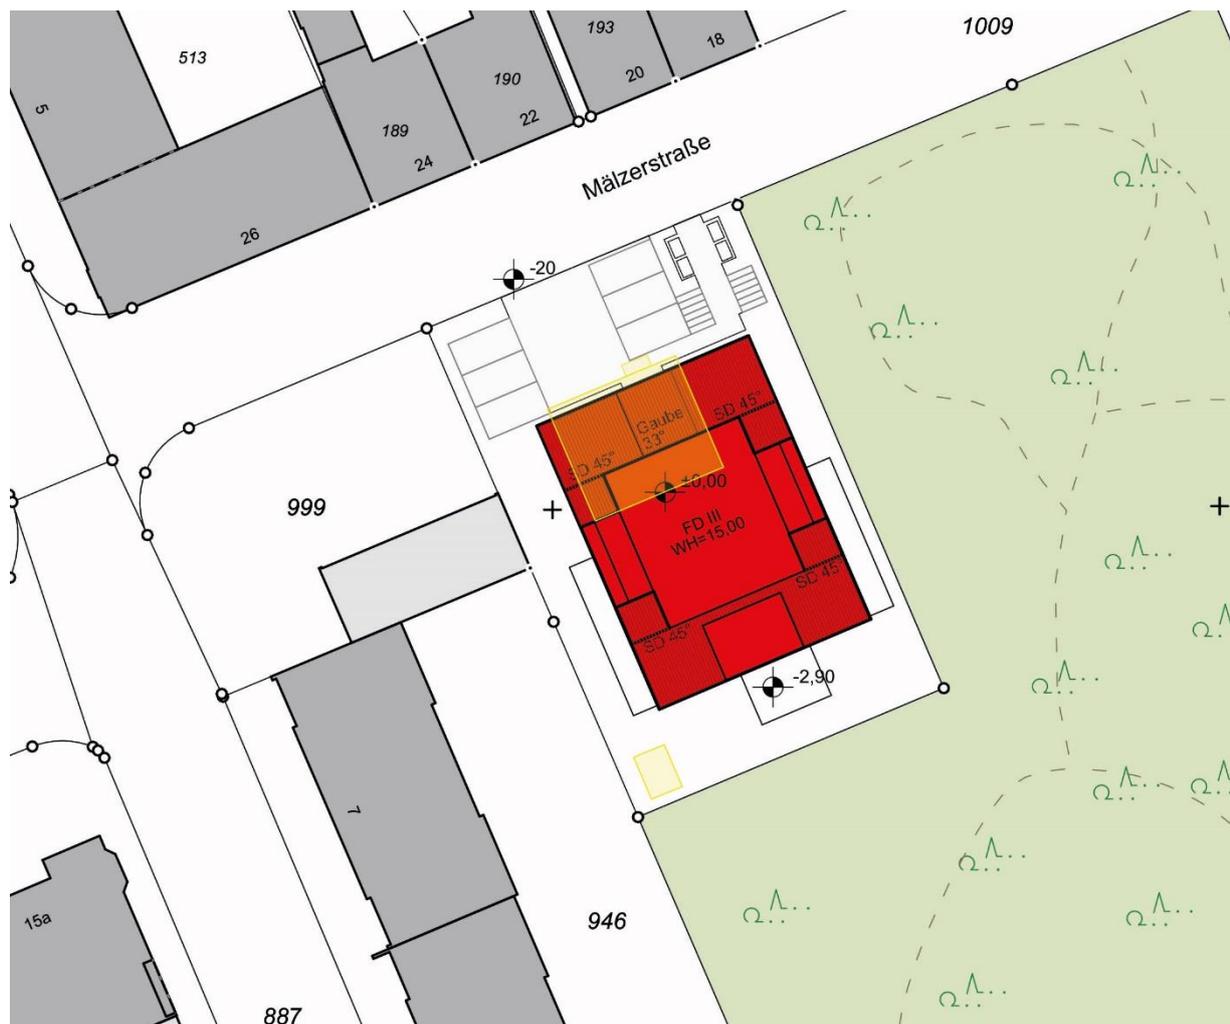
Lageplan des geplanten Gebäudes, o. M. (Quelle: Anja Dohle Architektin, Paderborn, 02/2023)
